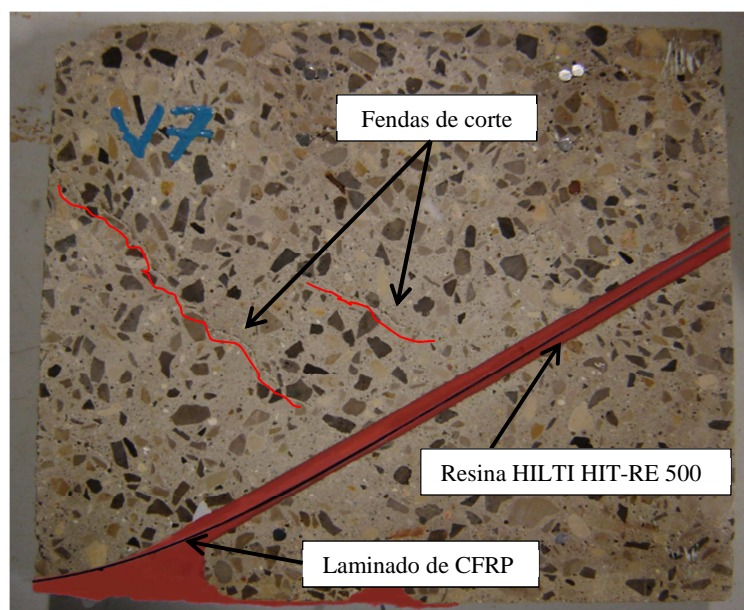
Corte longitudinal na zona de amarração do CFRP da viga V7
